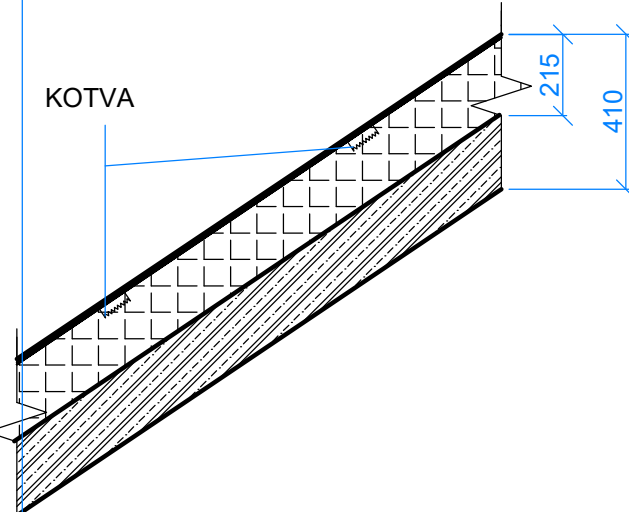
DETAIL PILASTRU NA SEVERNÍ FASÁDĚ
